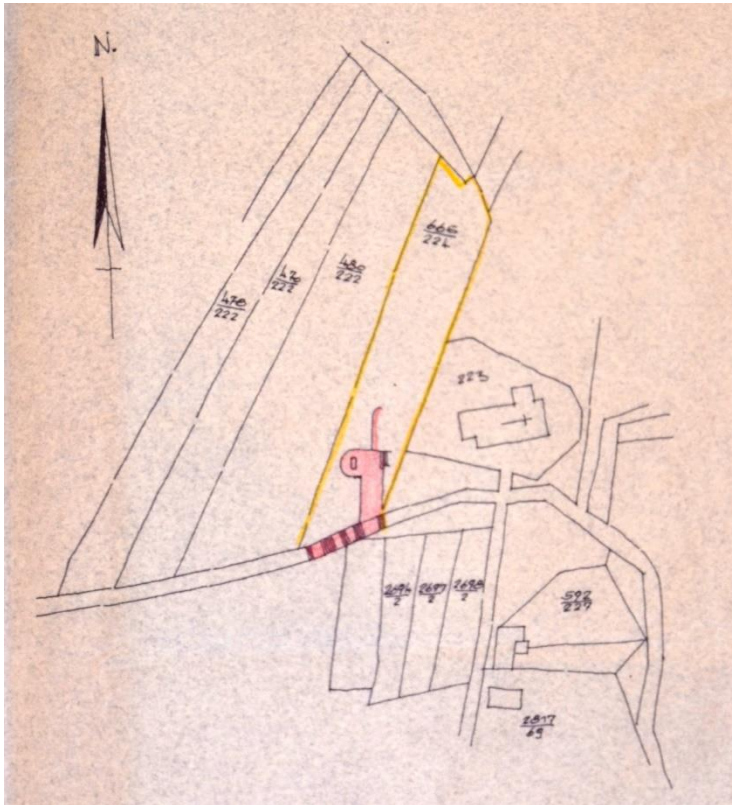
Lageplan vom 31.10.1960. Quelle: StA-Mechernich 18-14
